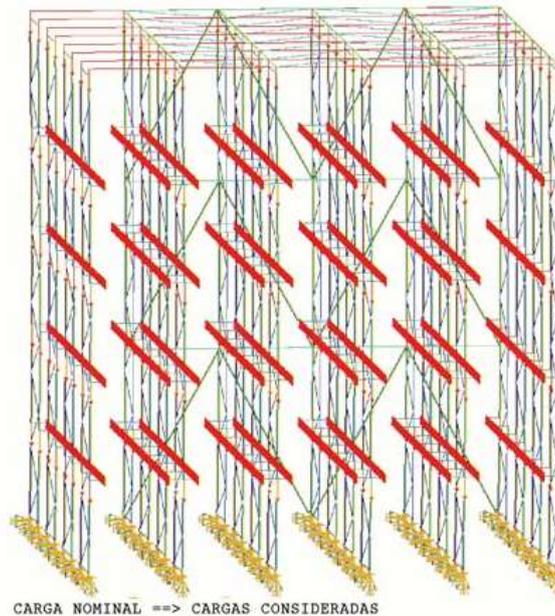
Ejemplo de análisis de cargas estáticas en un sistema de estanterías³³
